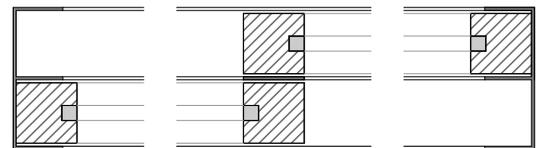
Pormenor construtivo da base de A a A' - 1/5
